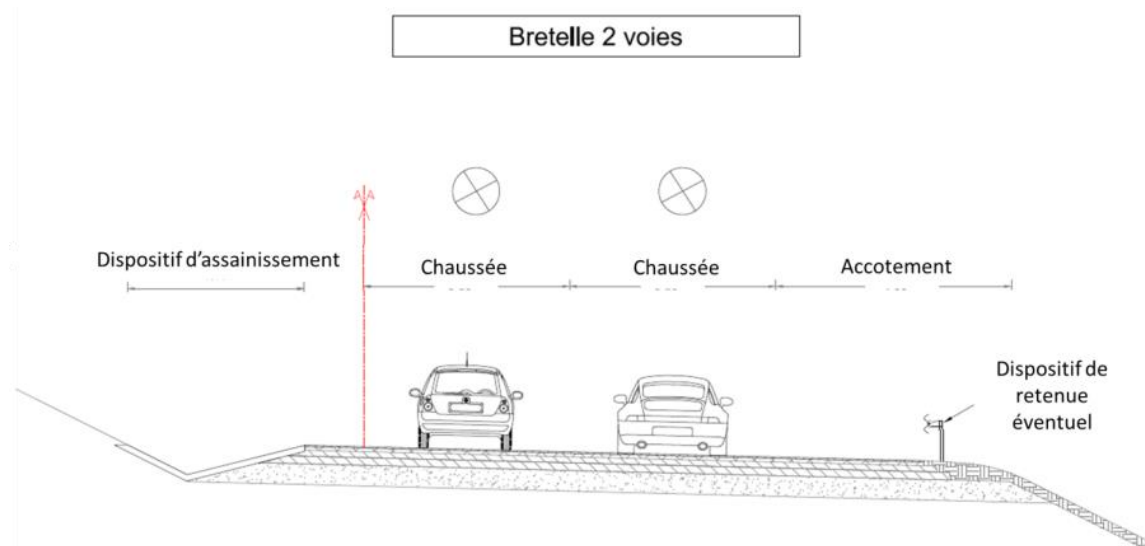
Profil en travers type mis en œuvre sur la bretelle de sortie n°1 à deux voies
